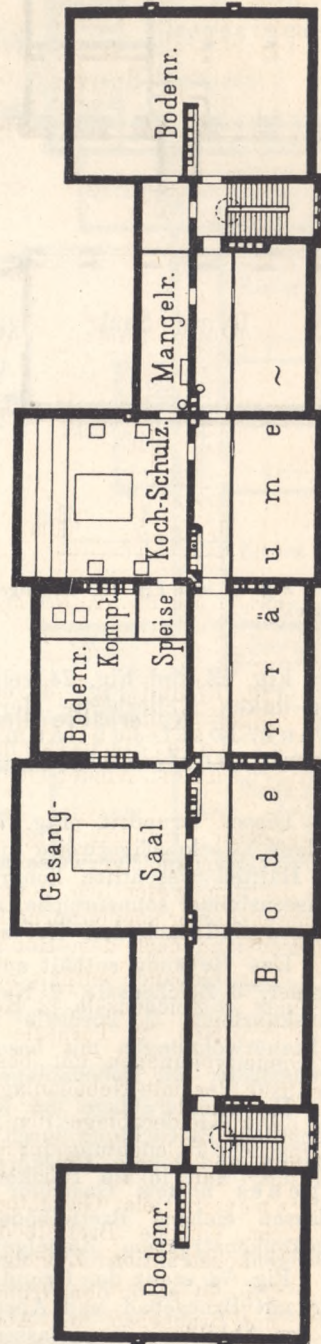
Grundriß des Dachgeschosses zu Fig. 68 (Volksschule in Kristiania, Herslebstraße).
